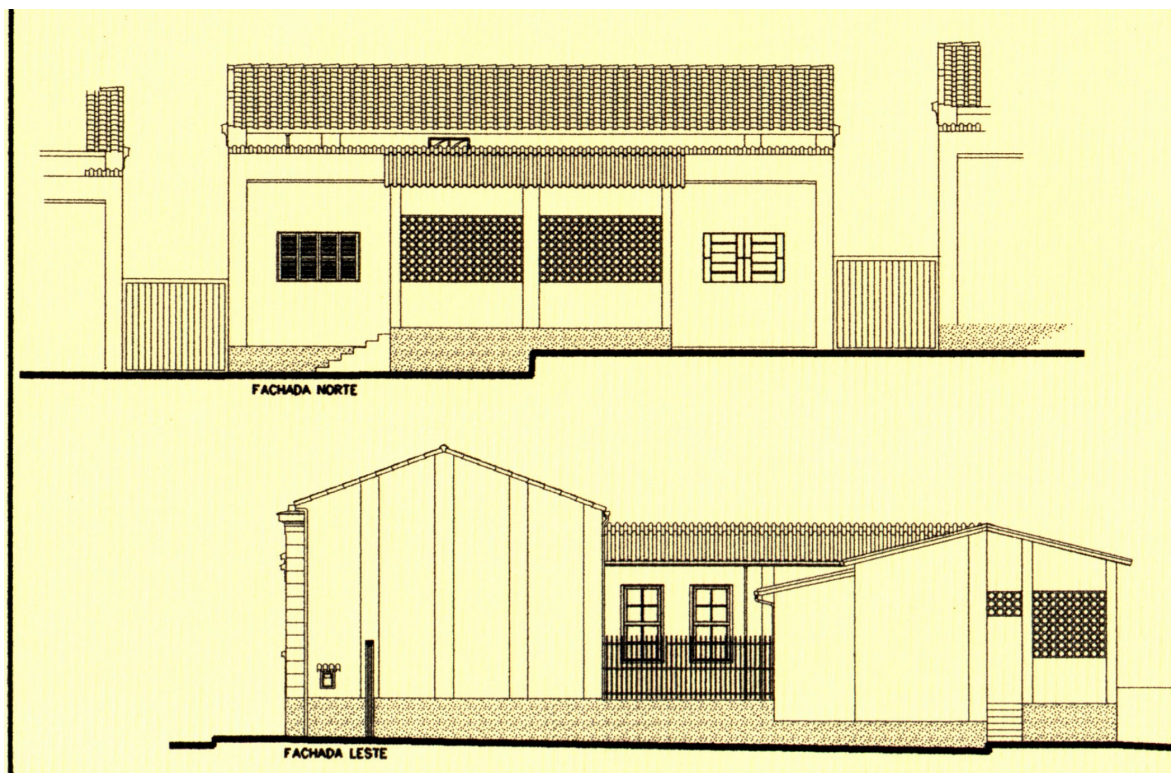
Fachadas posterior e lateral mostrando o acréscimo da área de serviço e o pátio central elevado. Projeto do autor.
